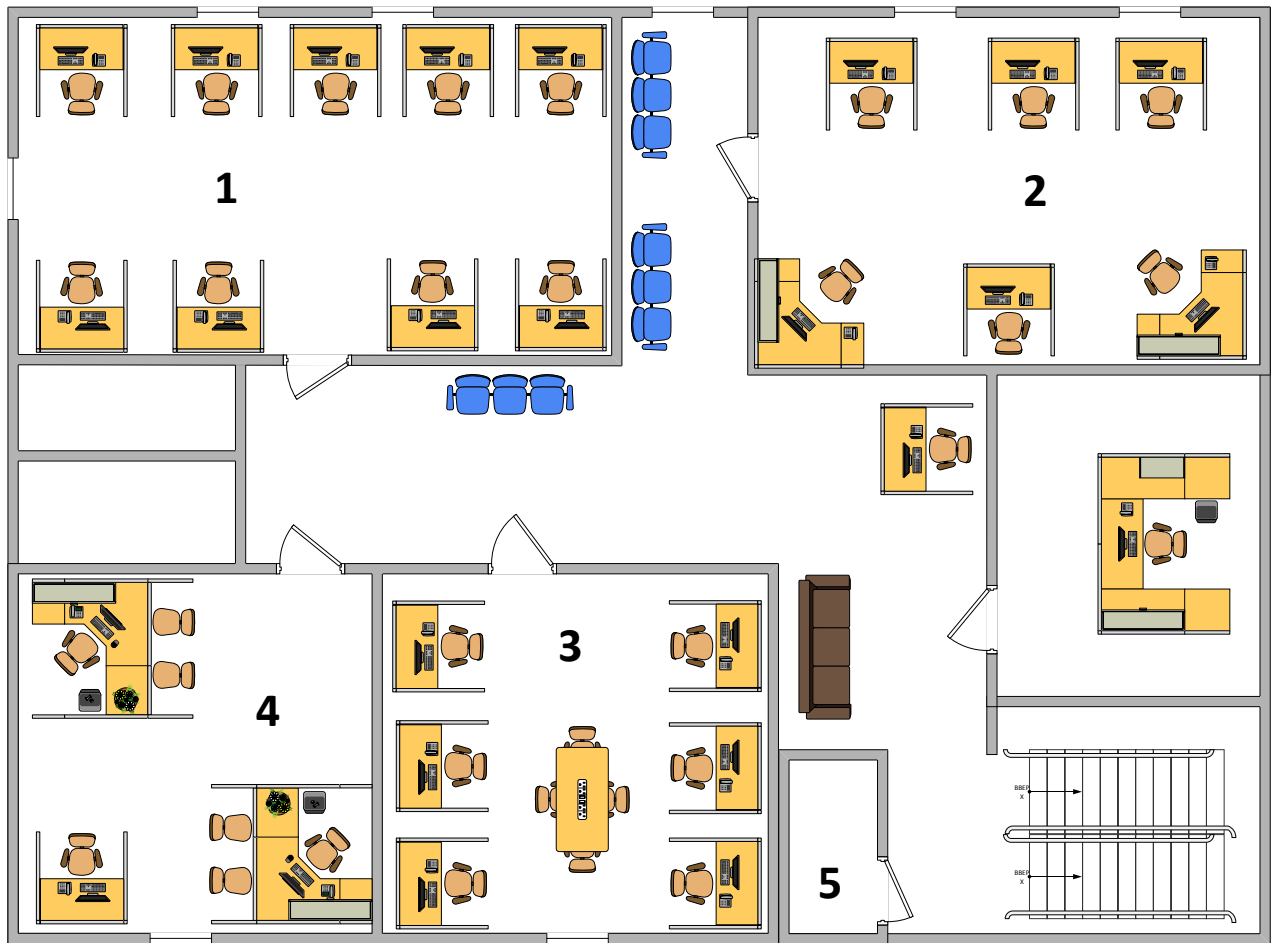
Топологічна схема, перша будівля поверх 2
